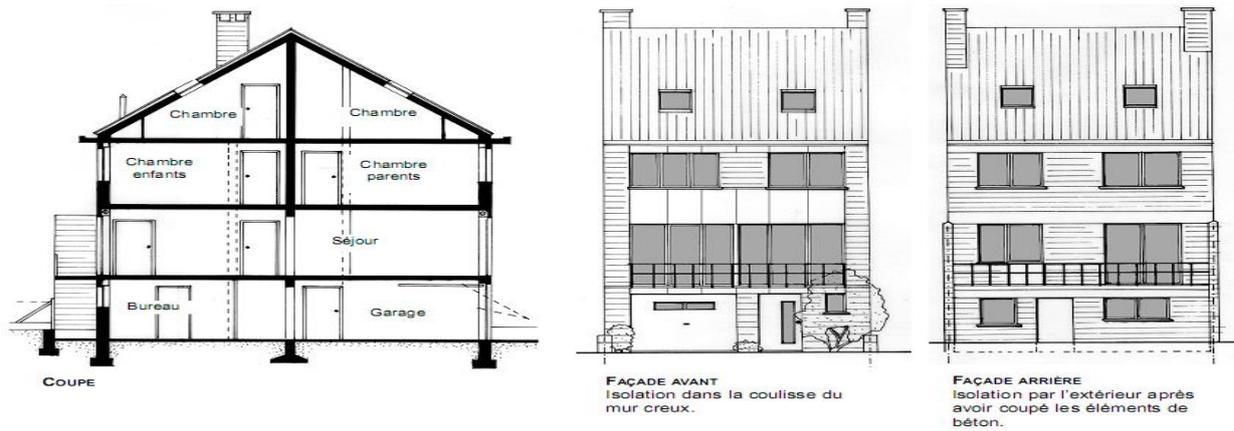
Plans, coupe et façades de l’habitation après transformations.
